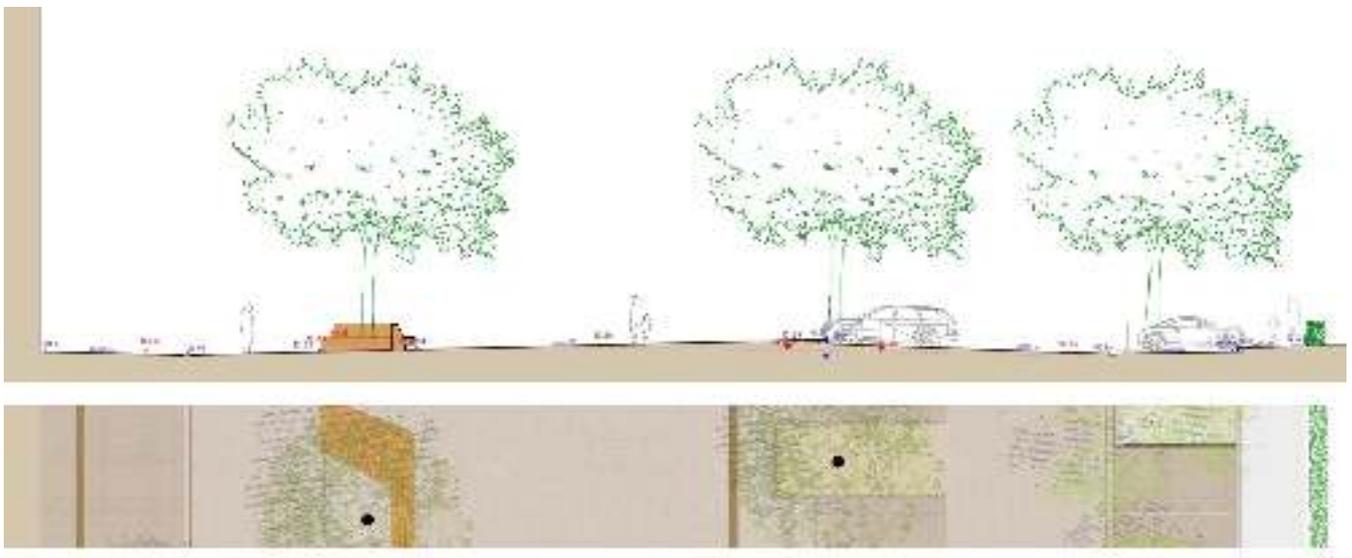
Querschnitt Parkplatz/Wieblinger Straße
